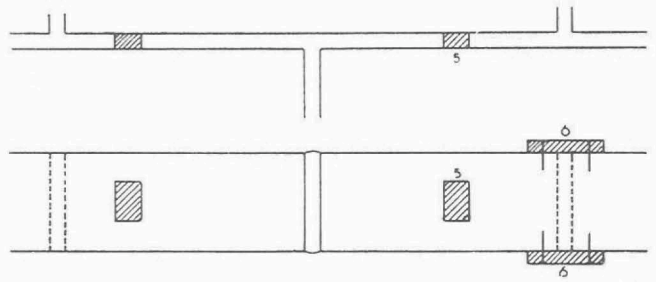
Lagerfuge. Ansicht und Schnitt. 5 = Betonklöße, 6 = Bretter zum Vergießen der Stoßfugen
